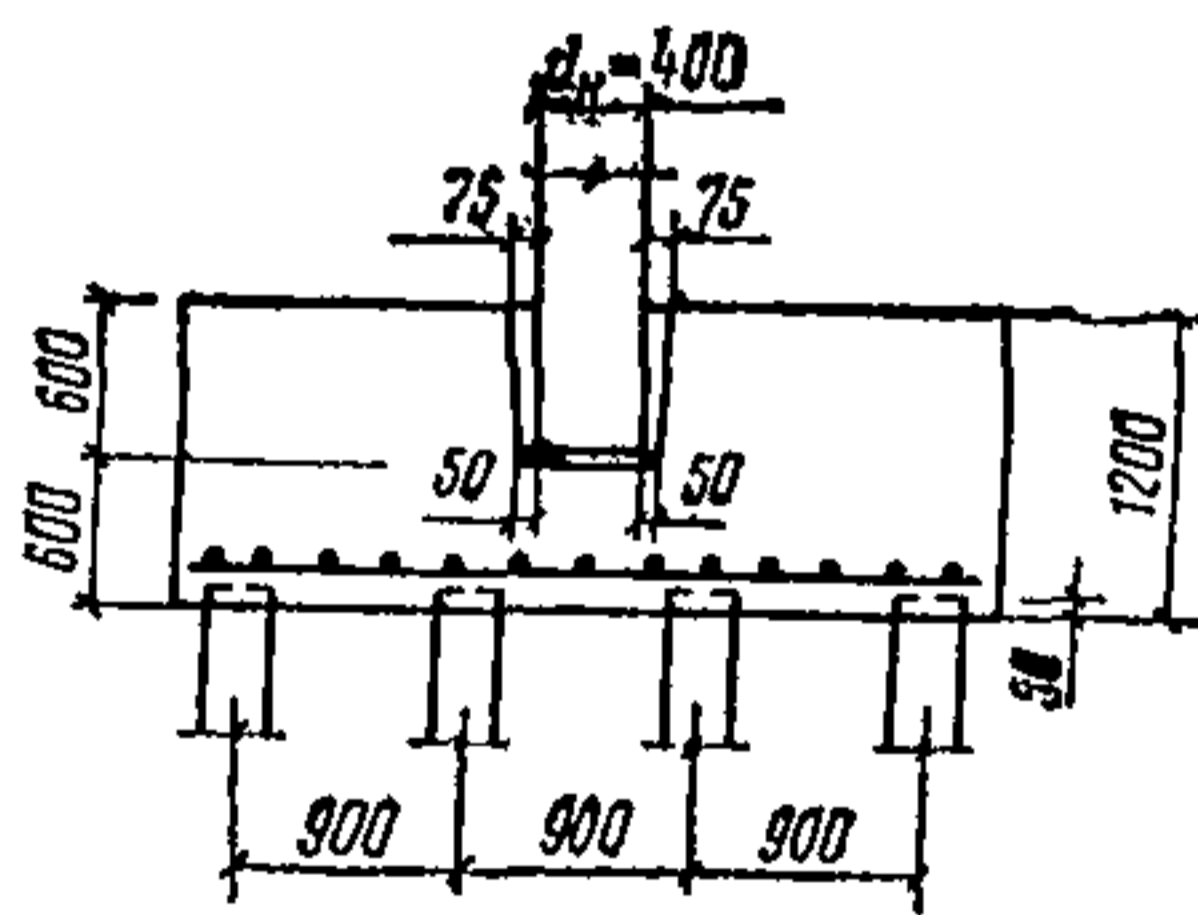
Плитный ростверк свайного фундамента под сборную железобетонную колонну
